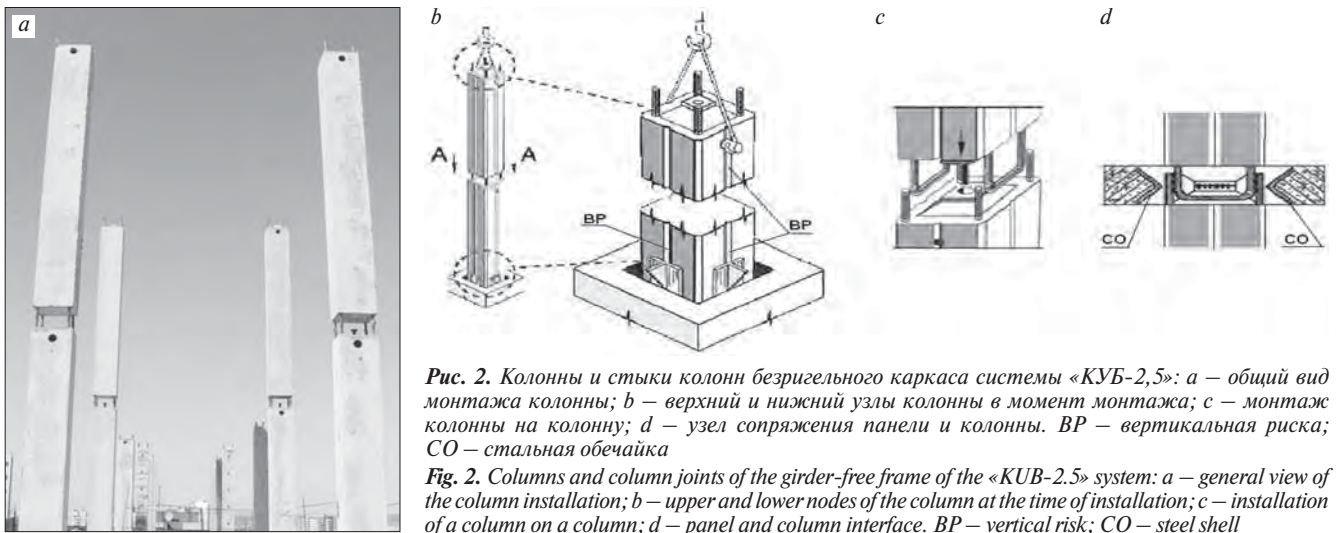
Колонны и стыки колонн безригельного каркаса системы «КУБ-2,5»: а – общий вид монтажа колонны; б – верхний и нижний узлы колонны в момент монтажа; с – монтаж колонны на колонну; д – узел сопряжения панели и колонны. ВР – вертикальная риска; СО – стальная обечайка
